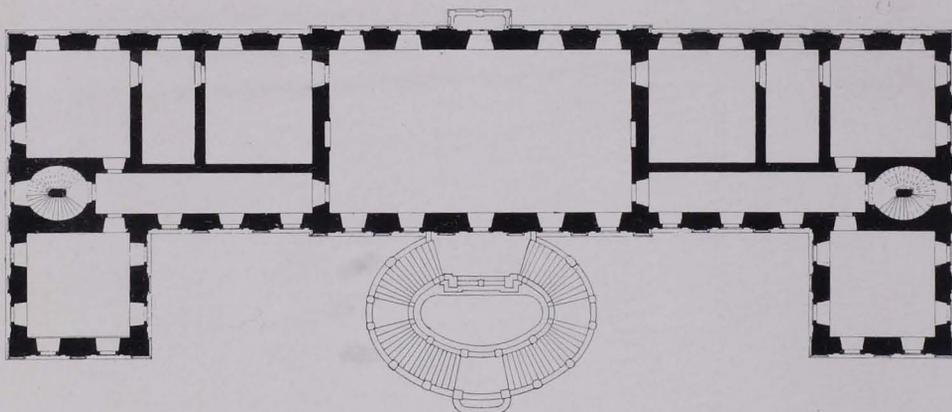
Prag, Schloß Troja. Grundriß 1. Stock
